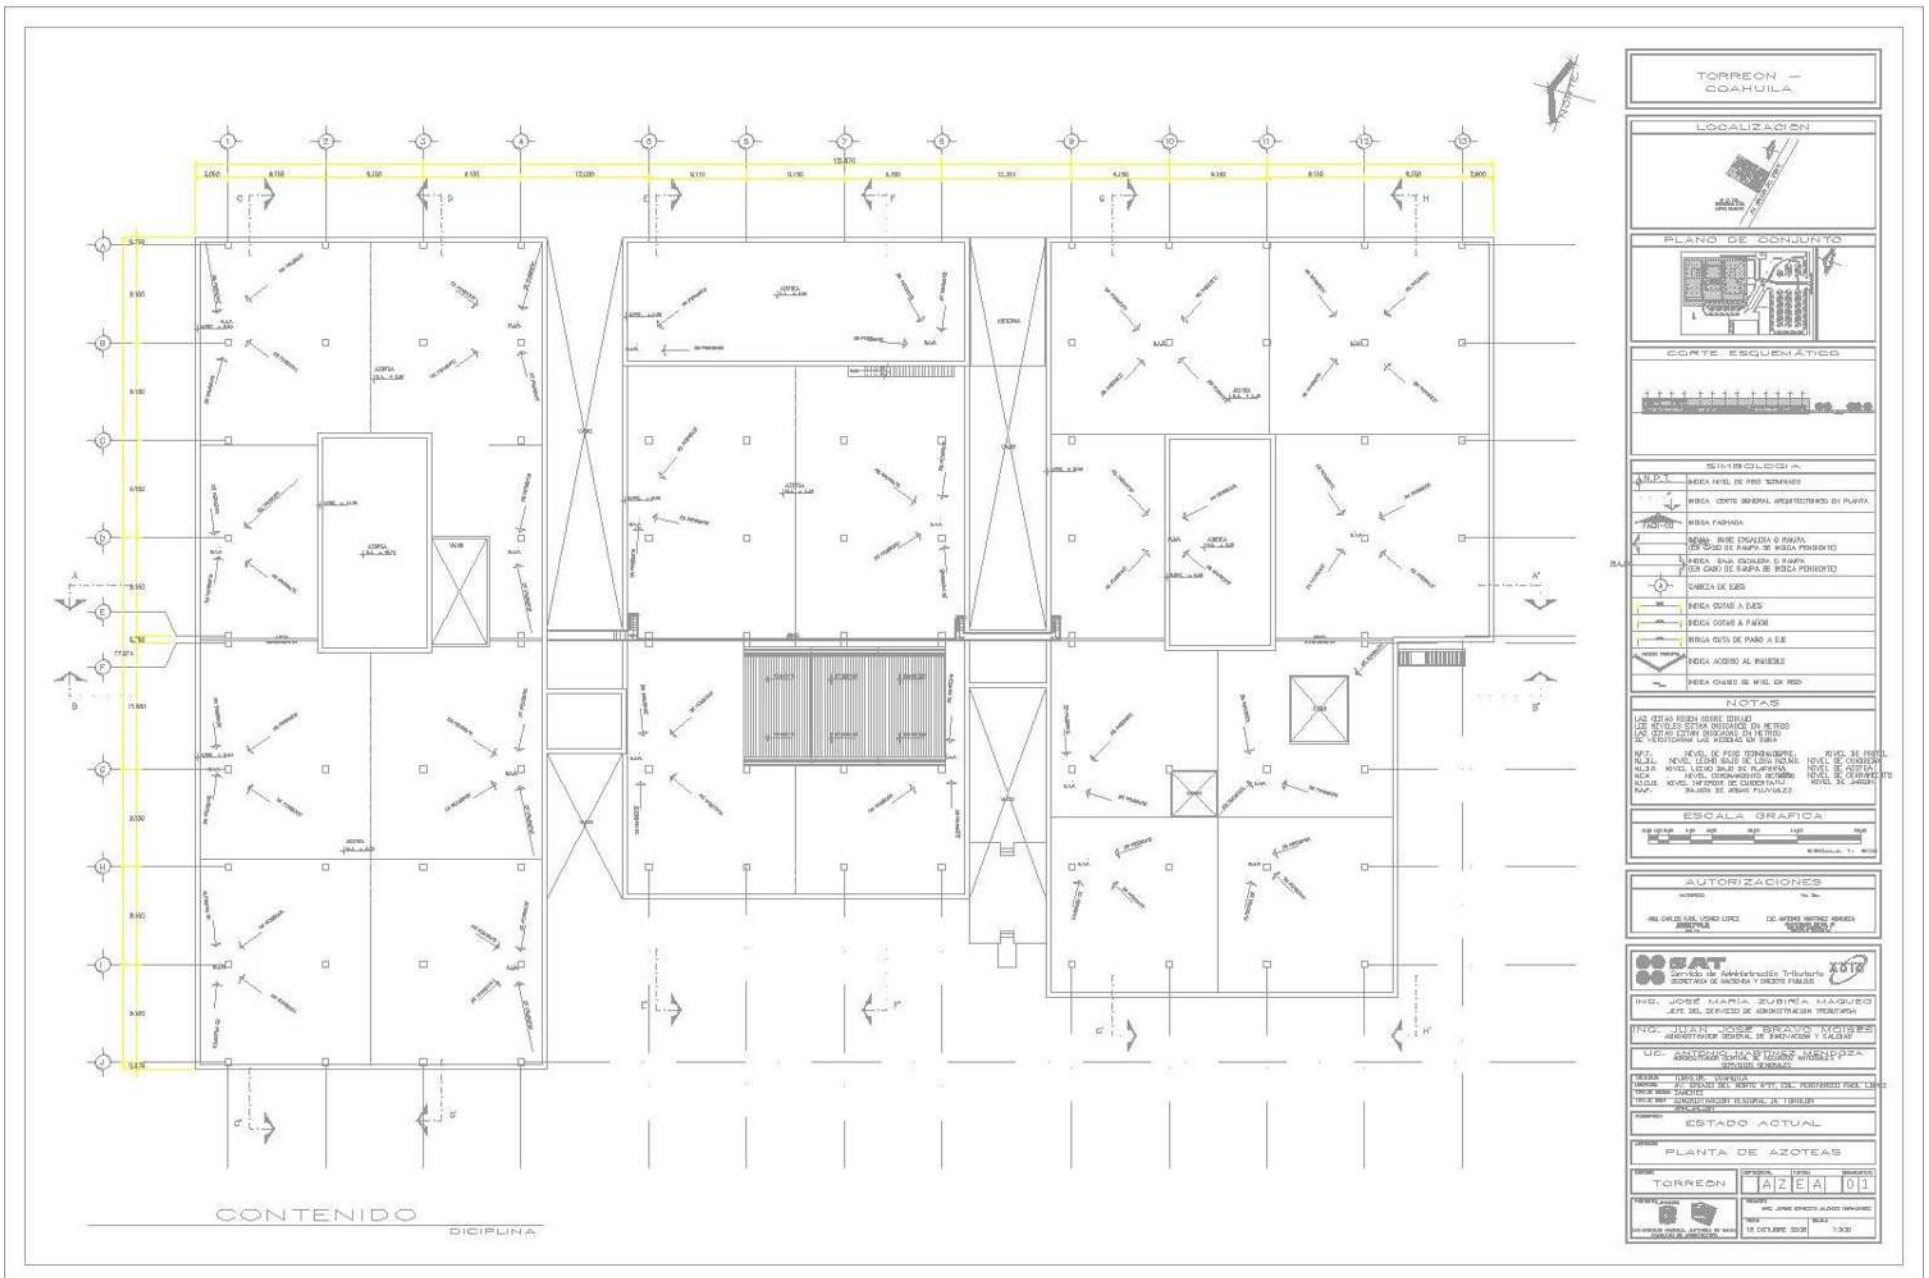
AZ-EA-01 planta de azoteas (estado físico de la obra)
